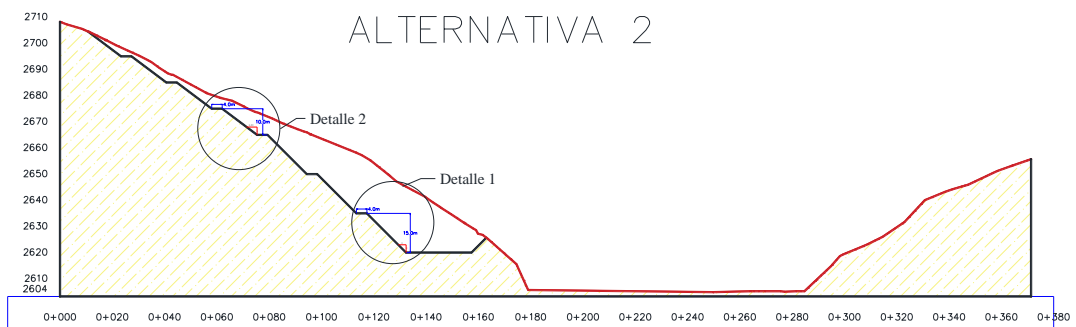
Alternativa 2, geometría de corte para trazado vial
